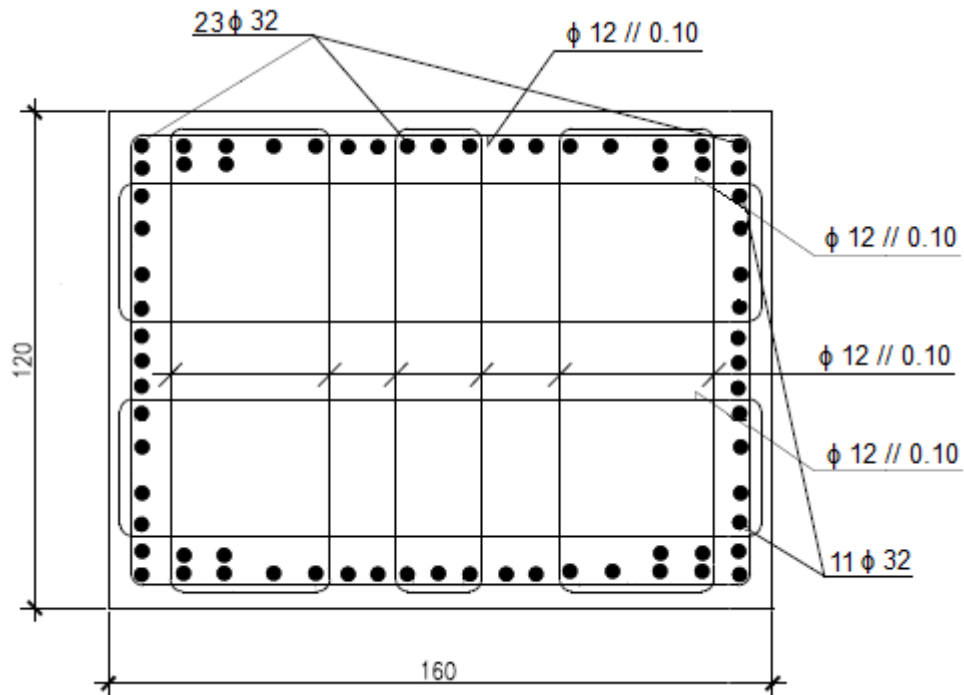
Solução final de armaduras para as secções de topo dos pilares
